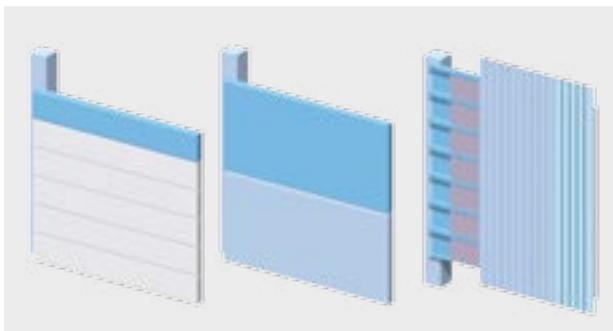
(v.l.) Porenbeton-, Stahlbetonwandplatten, Trapezblech-Kassettenwand
